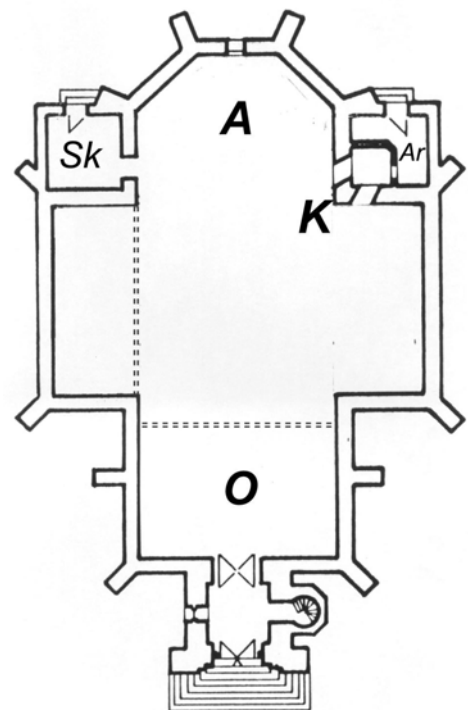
Grundriss Erdgeschoss, Situation vor der Umgestaltung und Neuausstattung 1963/64
